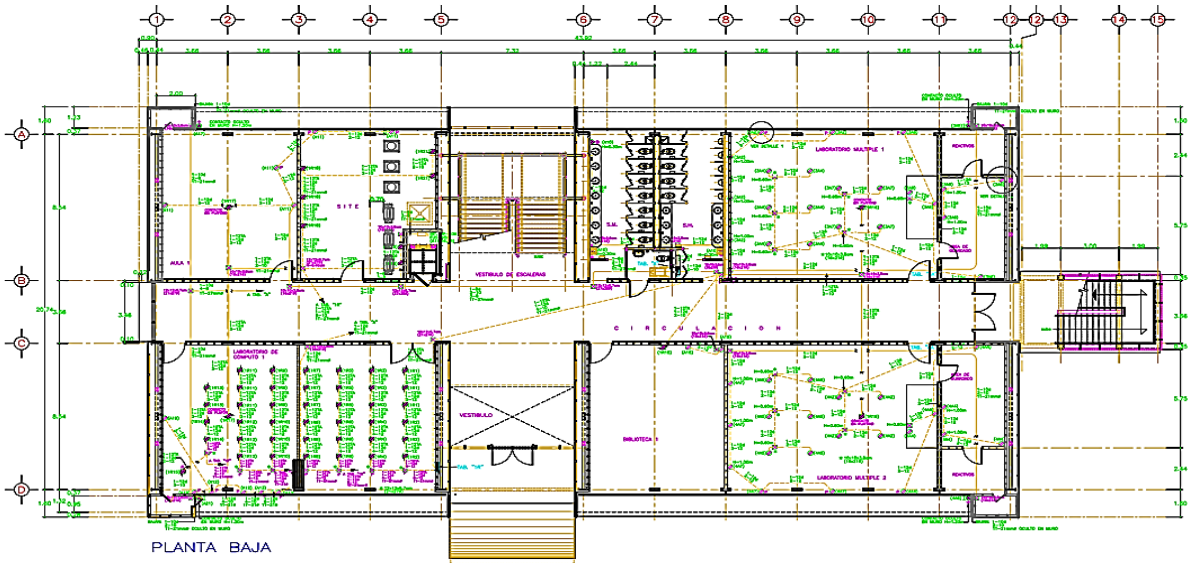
Vista en planta de ubicación de contactos en planta baja.
